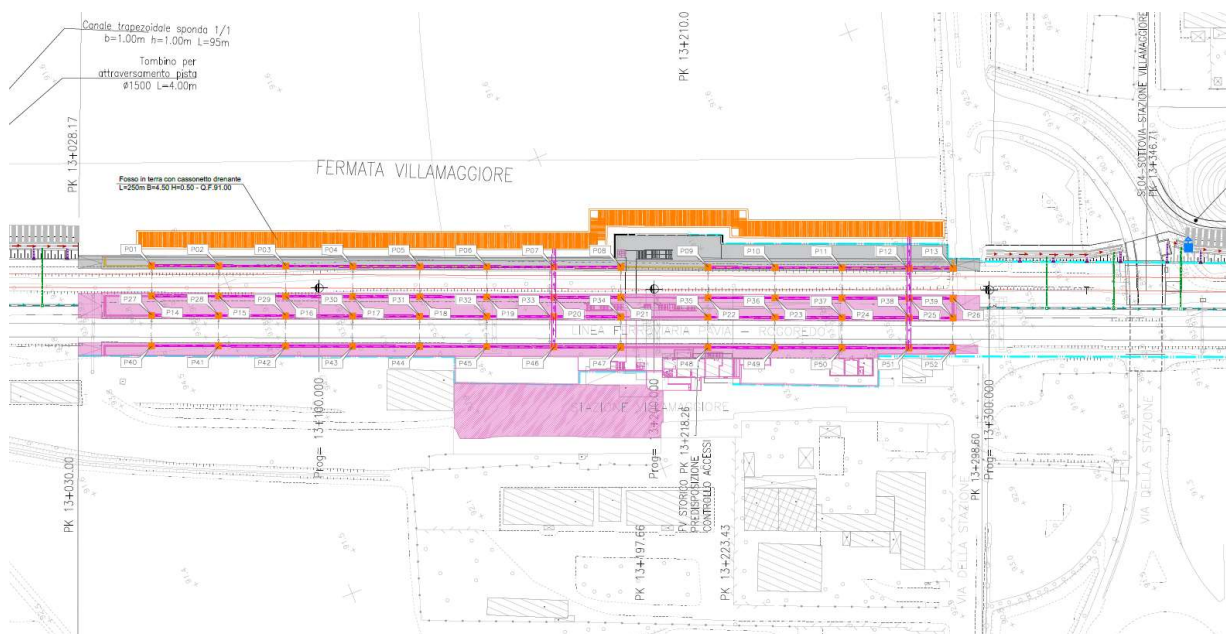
Stralcio planimetrico elaborato NM0Z20D26P8FV030B001A
